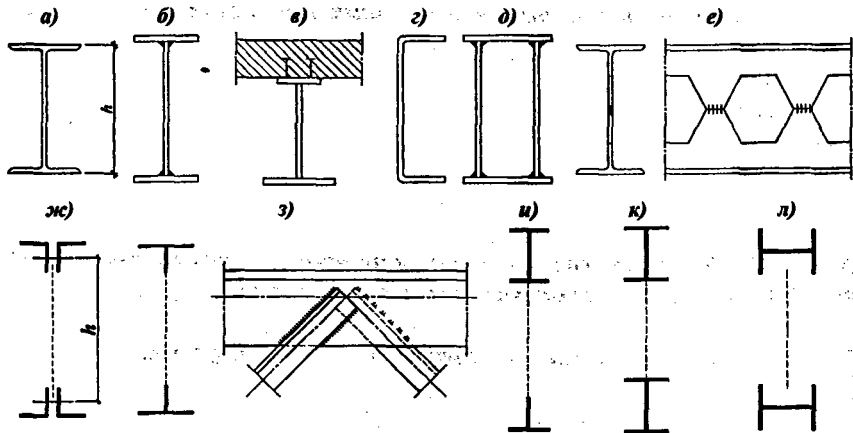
Типы сечений ригелей, балок и ферм перекрытия:
